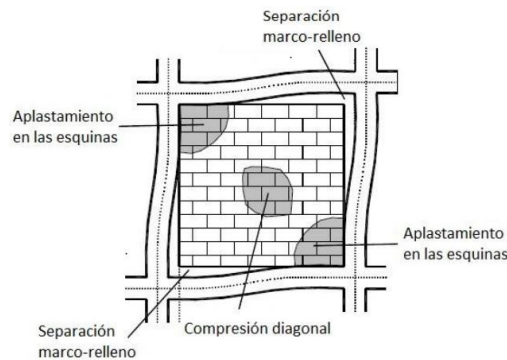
Aplastamiento en las esquinas y compresión diagonal en el panel de mampostería.
